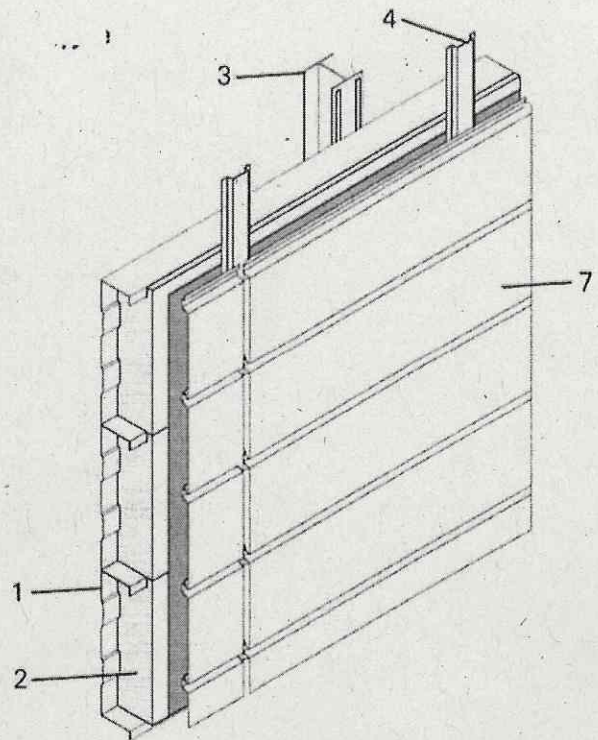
Schema des Baus einer Wand- Wände mit Fassade aus Kassetten
